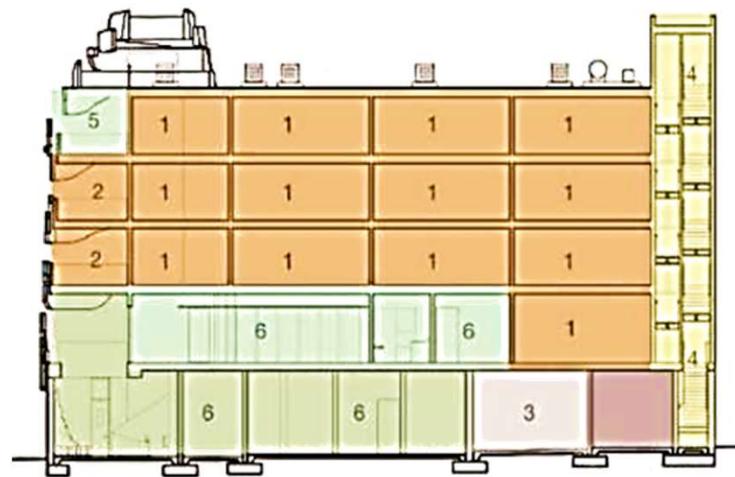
Corte Transversal La Brea | Autor: Patrick Tighe Architecture
